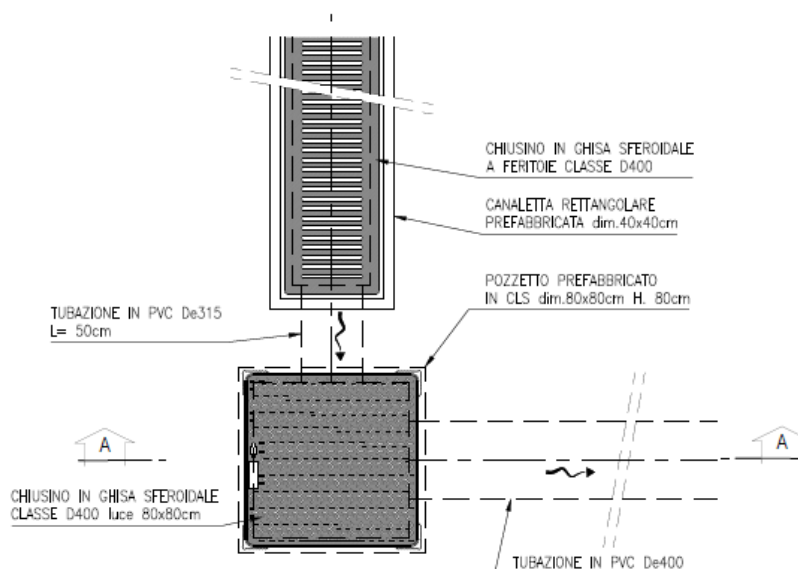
Dettaglio di scarico della canaletta centrale nel pozzetto 0.8x0.8 m.
